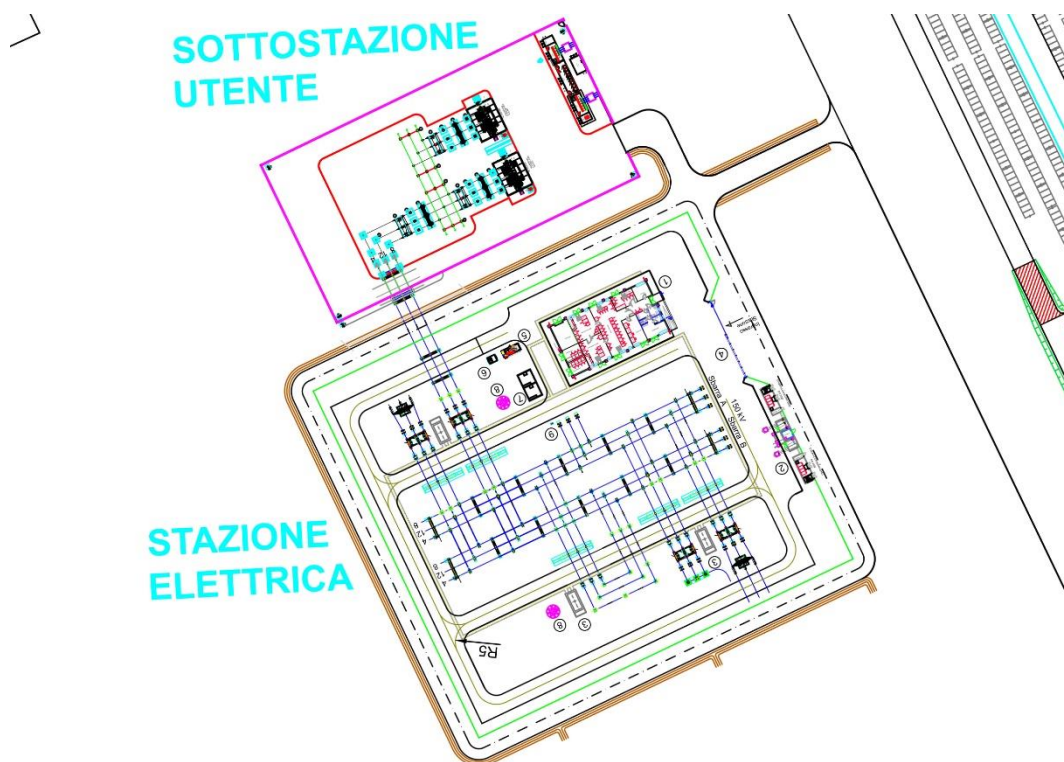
Dettaglio layout SE e SSU con fossato di drenaggio.
